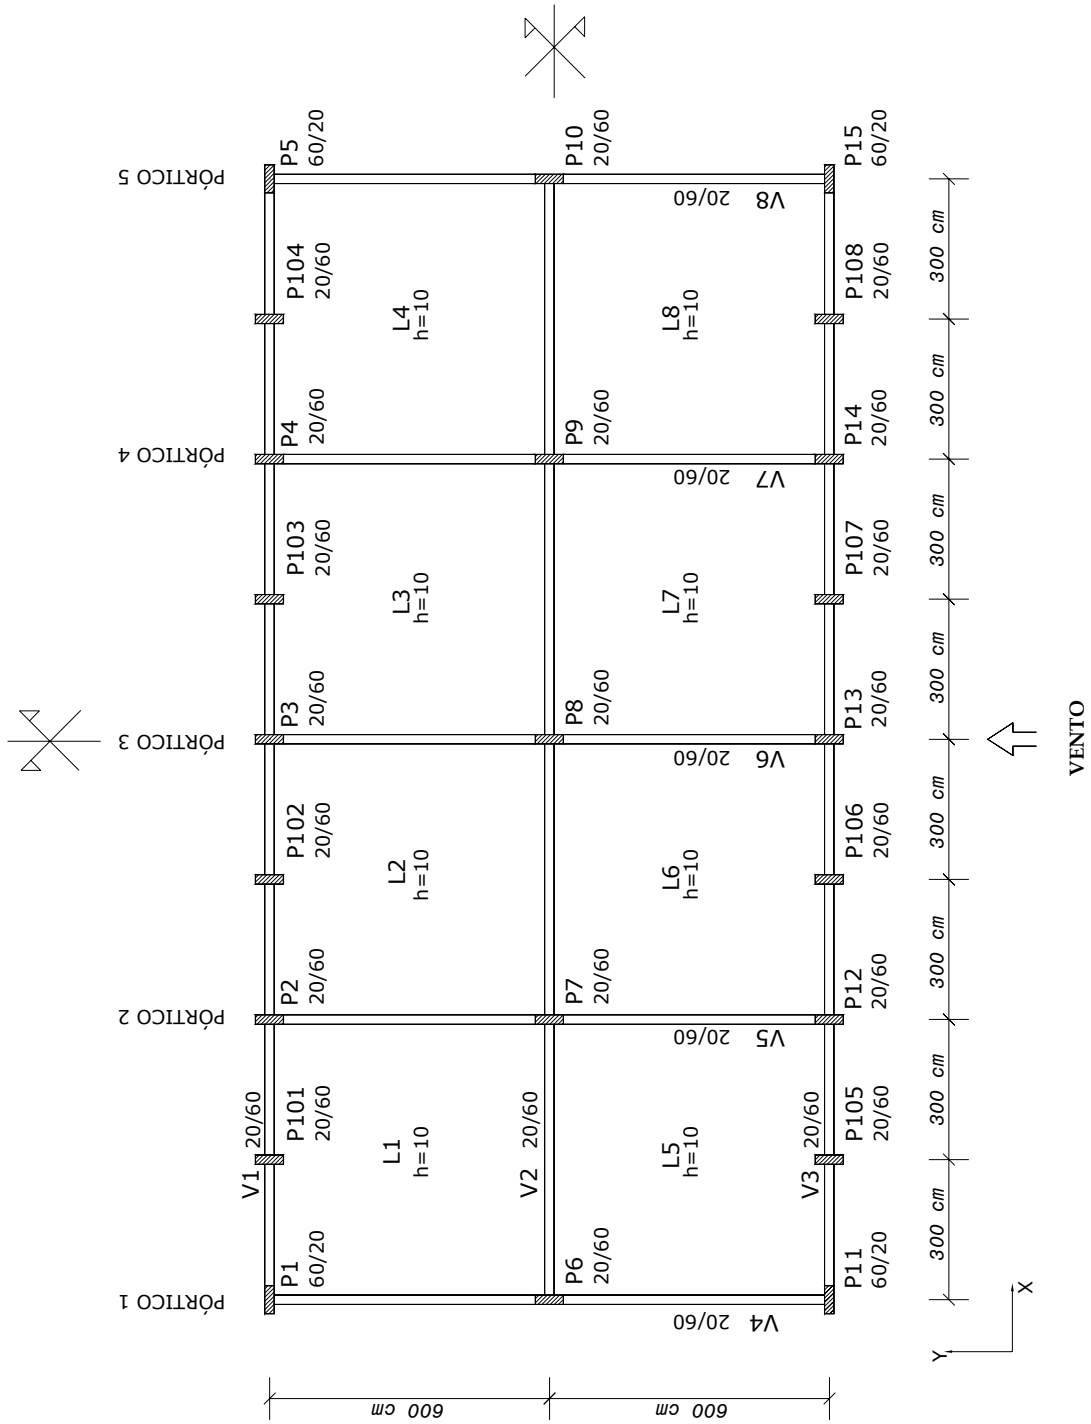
Forma do pavimento tipo da Estrutura 2.
